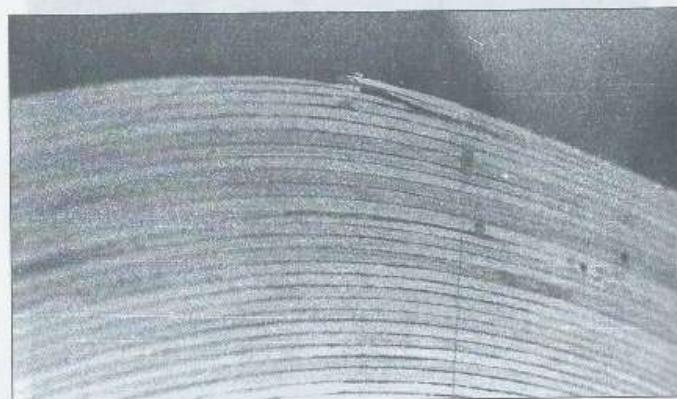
Разрушение ДГРП в области закругления с первичным разрывом краевых растянутых волокон под незначительным углом
